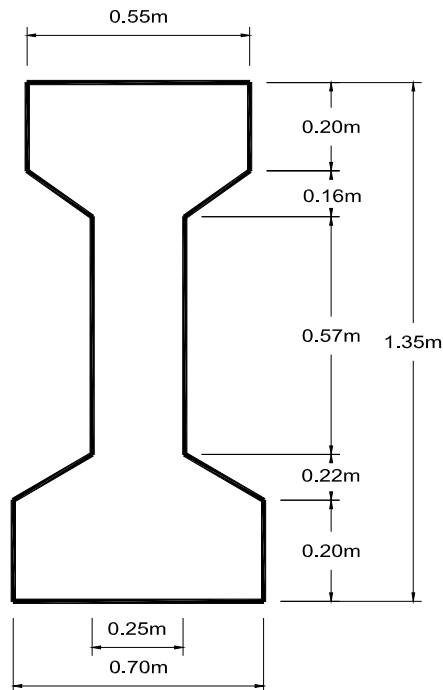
Dimensiones de las vigas I del puente Maravatío km 239.
